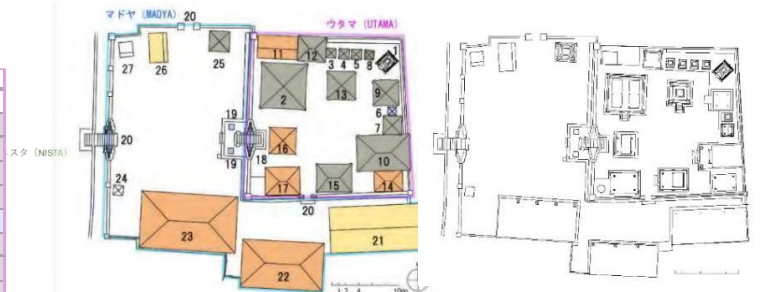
ムルタサリ寺院の配置図および屋根材 図5 ムルタサリ寺院の平面図
